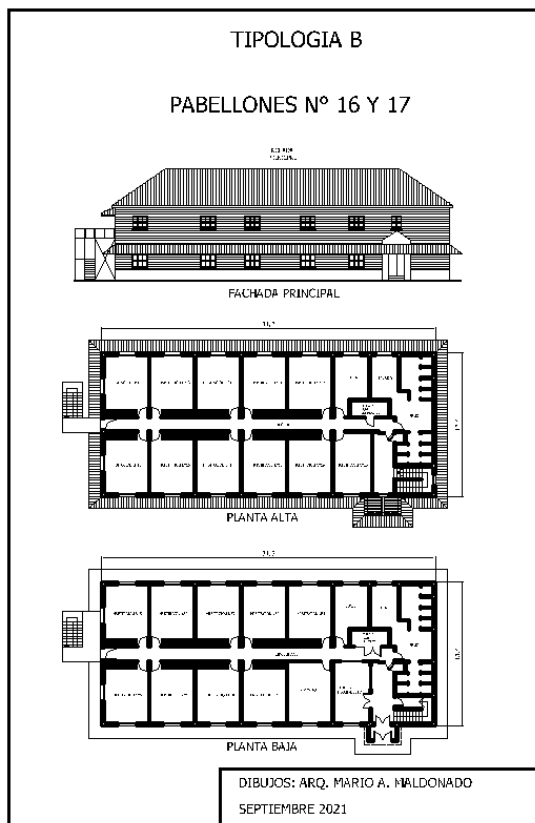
Vista y plantas del Pabellón Tipo “B”. Elaboración: Arq. Mario Maldonado (2021).
